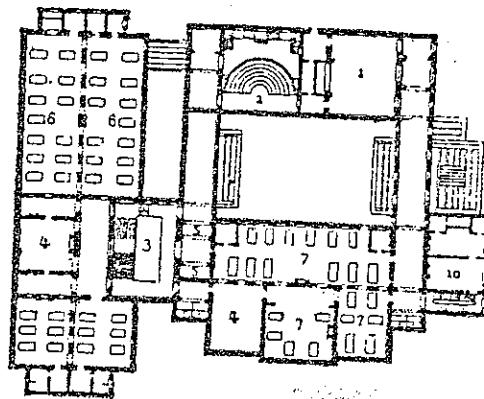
Plan de l'hôpital de King's College à Londres.
